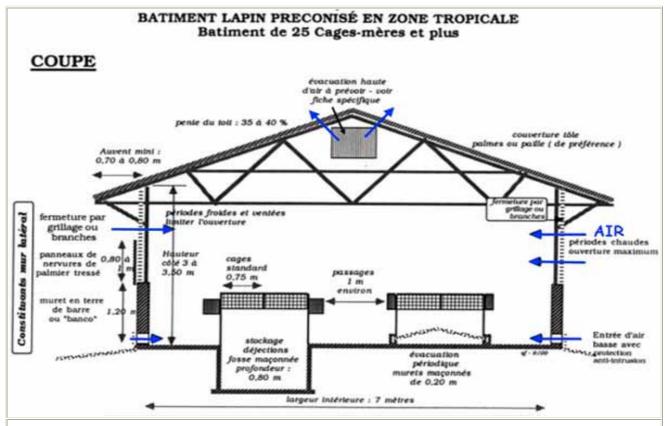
Plan de coupe d'un bâtiment pour 25 cages-mères et plus
